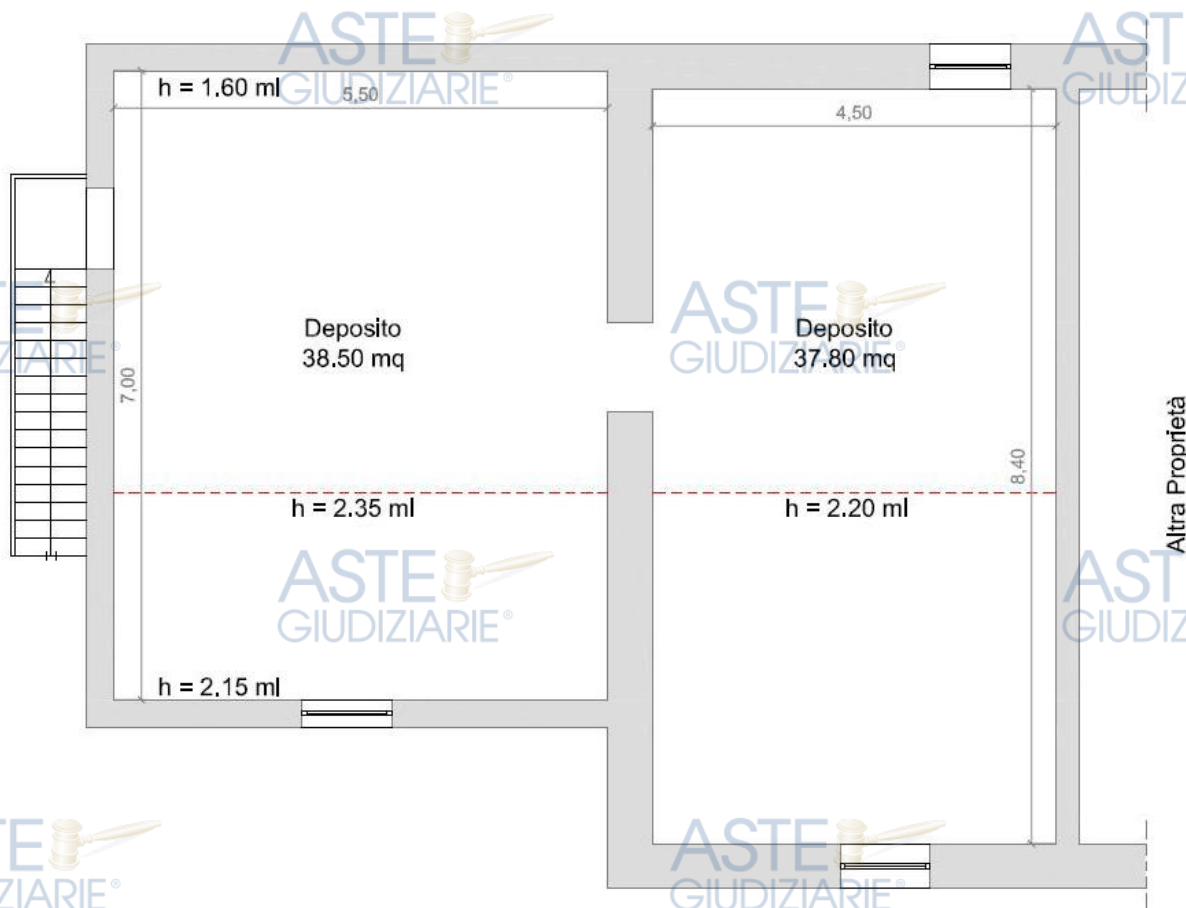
Planimetria Stato di Fatto Piano Primo Foglio 31, p.lla 1253.
